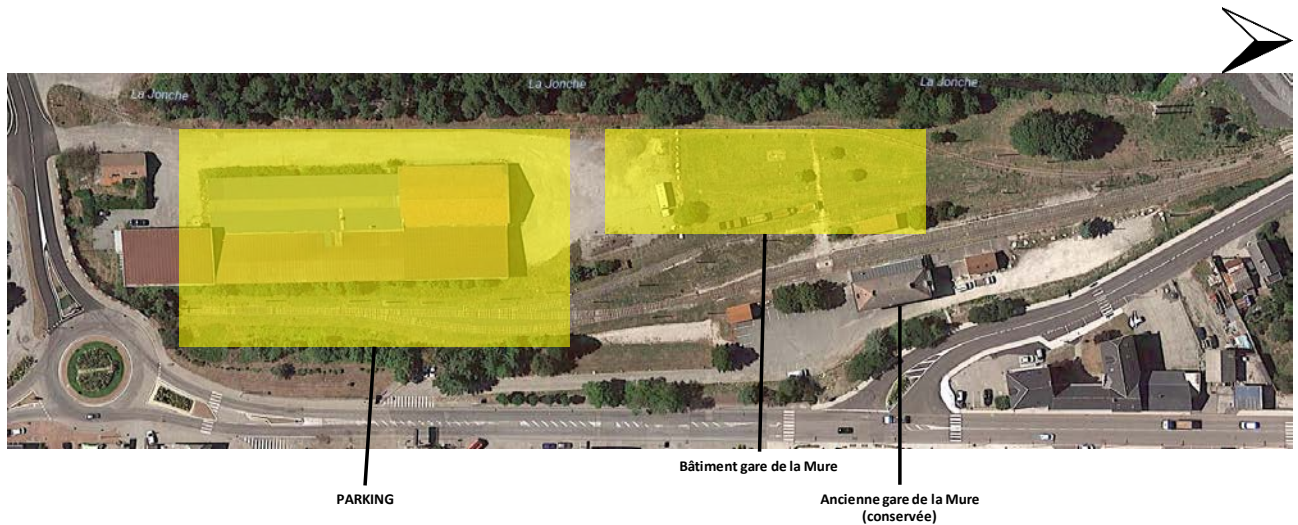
Implantation et emprise du bâtiment gare de La Mure – CDEM et Parking (plan susceptible d'évoluer)
